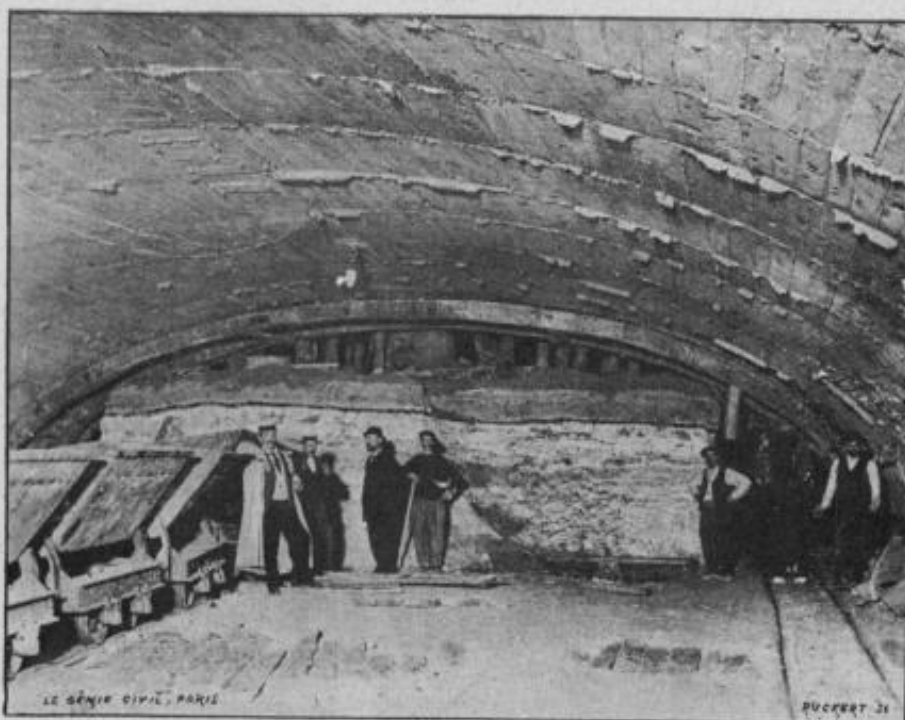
Construction de la station de l'Avenue de Wagram ;
